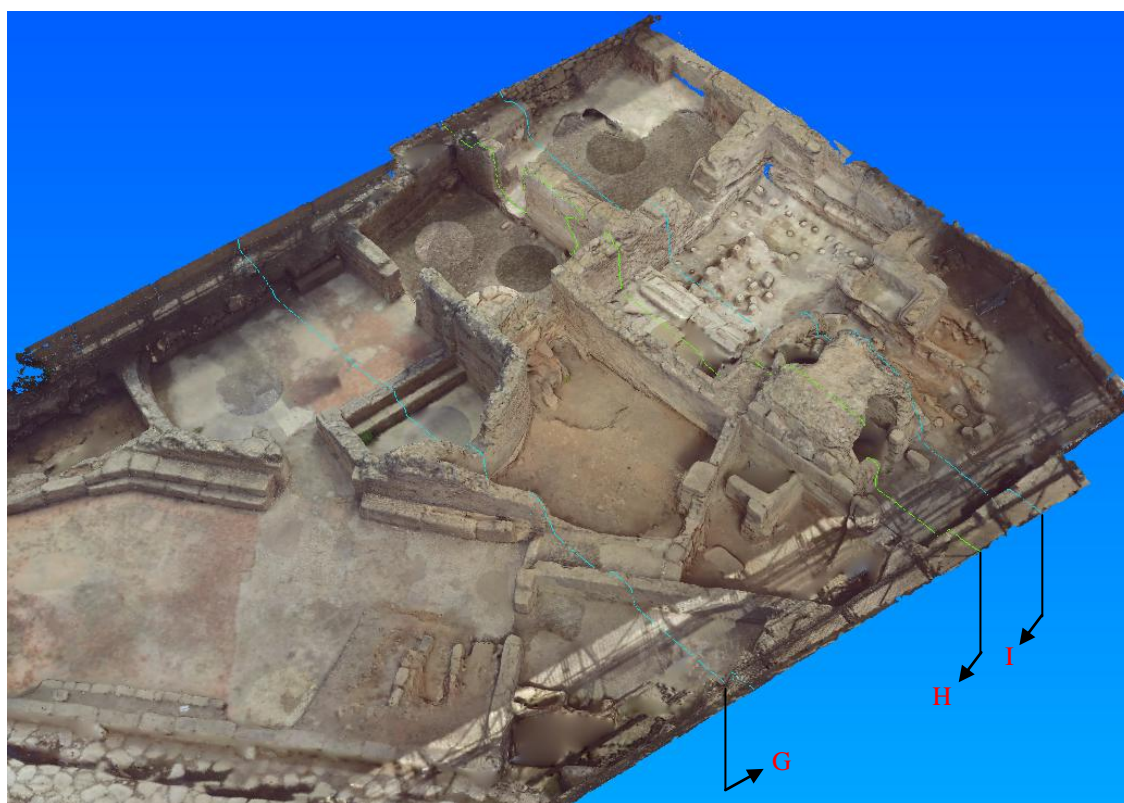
Particolare delle terme con indicazione dei tagli delle sezioni-prospetto: in base all'articolazione delle strutture si è deciso di orientare la vista del piano.
